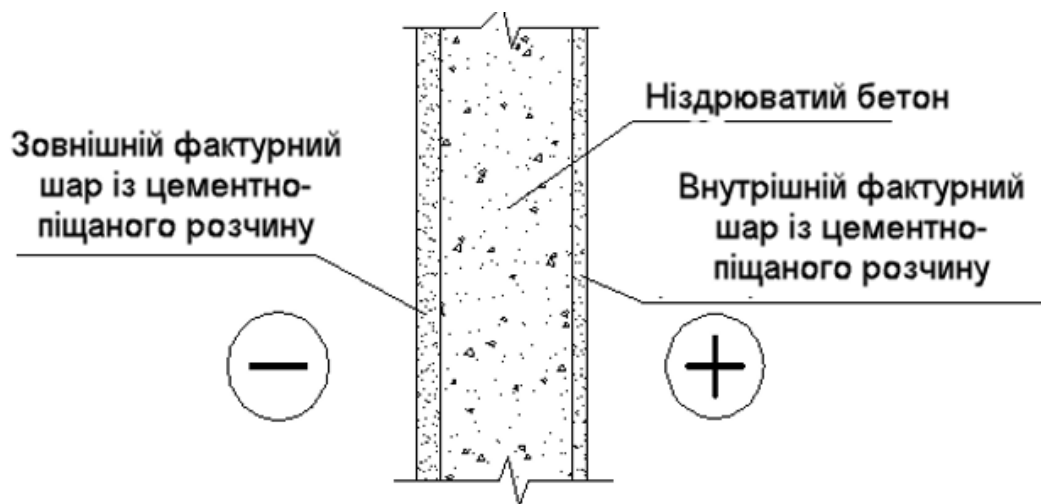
Схема стінової панелі іздрюватого бетону
